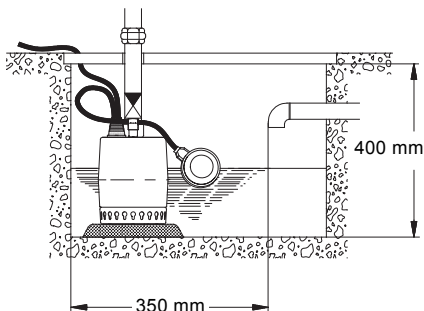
Dimensões mínimas do poço para a bomba Unilift KP-A
